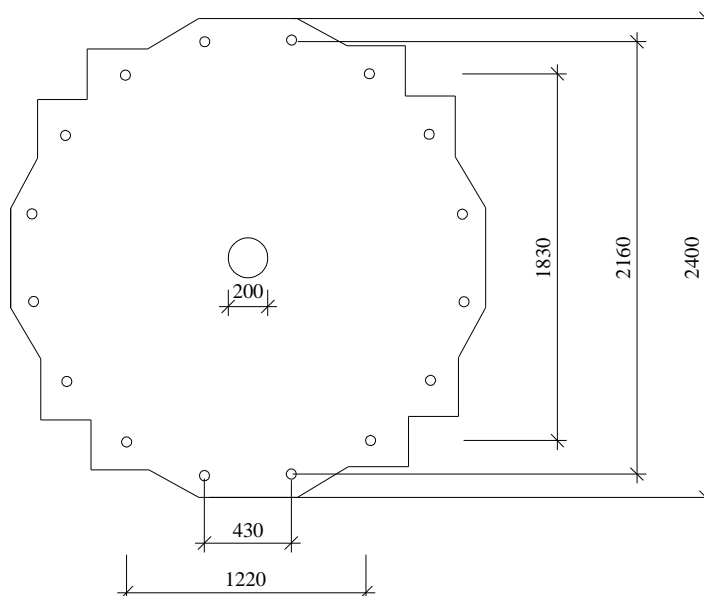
Plano do esquema dos ensaios de Kordina e Nölting
